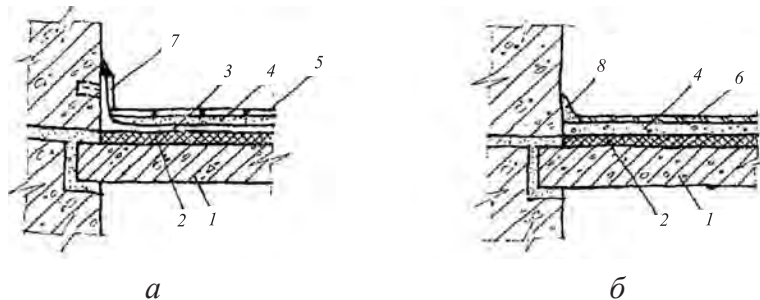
Полы с водостойким покрытием: *а* — из керамических плиток; *б* — со сплошным покрытием: 1 — плита перекрытия; 2 — звукоизоляция; 3 — гидроизоляция; 4 — стяжка; 5 — керамическая плитка; 6 — мозаичное покрытие (терраса); 7 — плинтус из керамических плиток; 8 — плинтус из цементно-песчаного раствора
